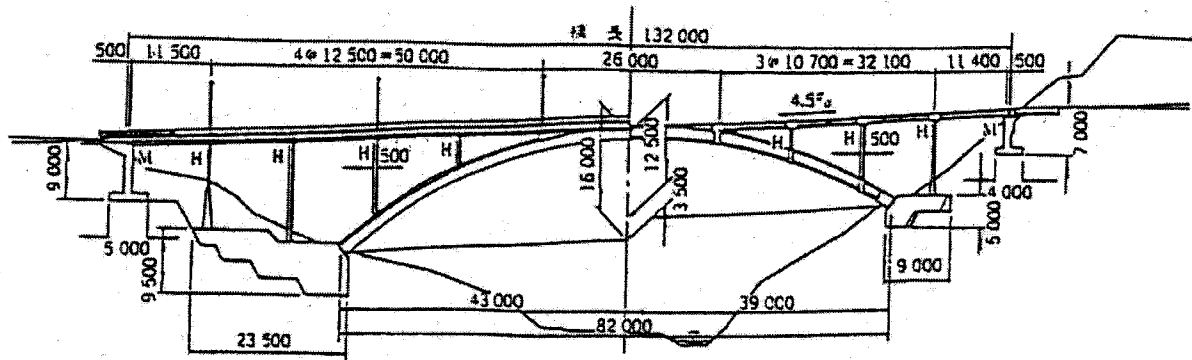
城址橋の一般図 (寸法単位: mm) ²⁾
